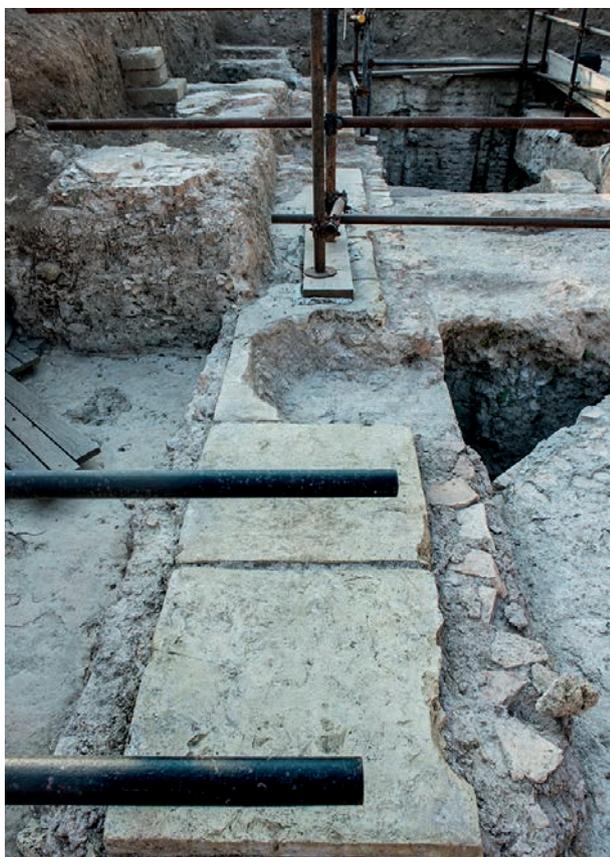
Les briques bipédales placées à la base du mur n° 92 et la fondation qui prend appui directement sur la structure néronienne et mesure, à cet endroit, moins de 10 cm de hauteur (vue orientée vers l'est; cliché Ch. Durand).
